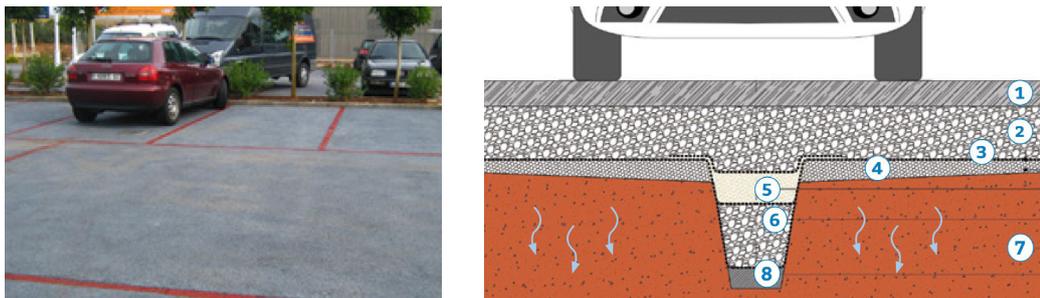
Imagen y esquema de aparcamiento con pavimento drenante de hormigón poroso.
